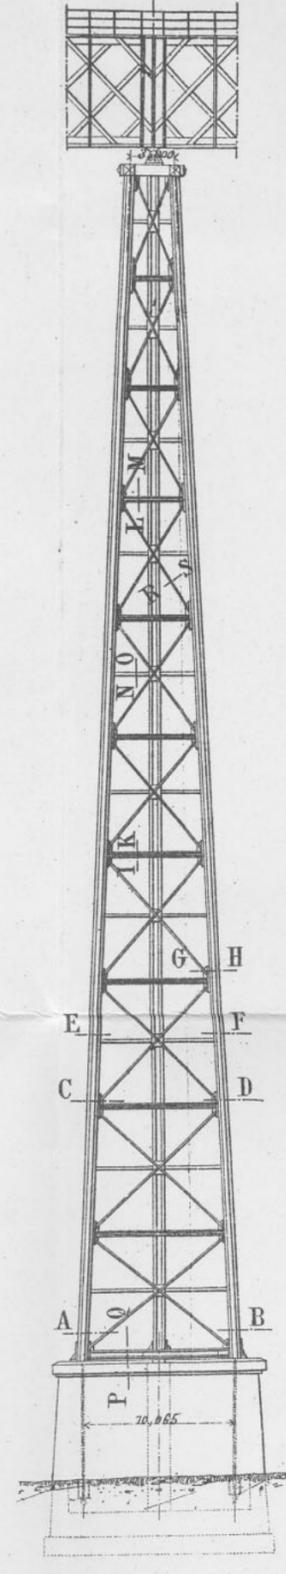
Vista de lado de una pila metálica (Escala 1/400)
